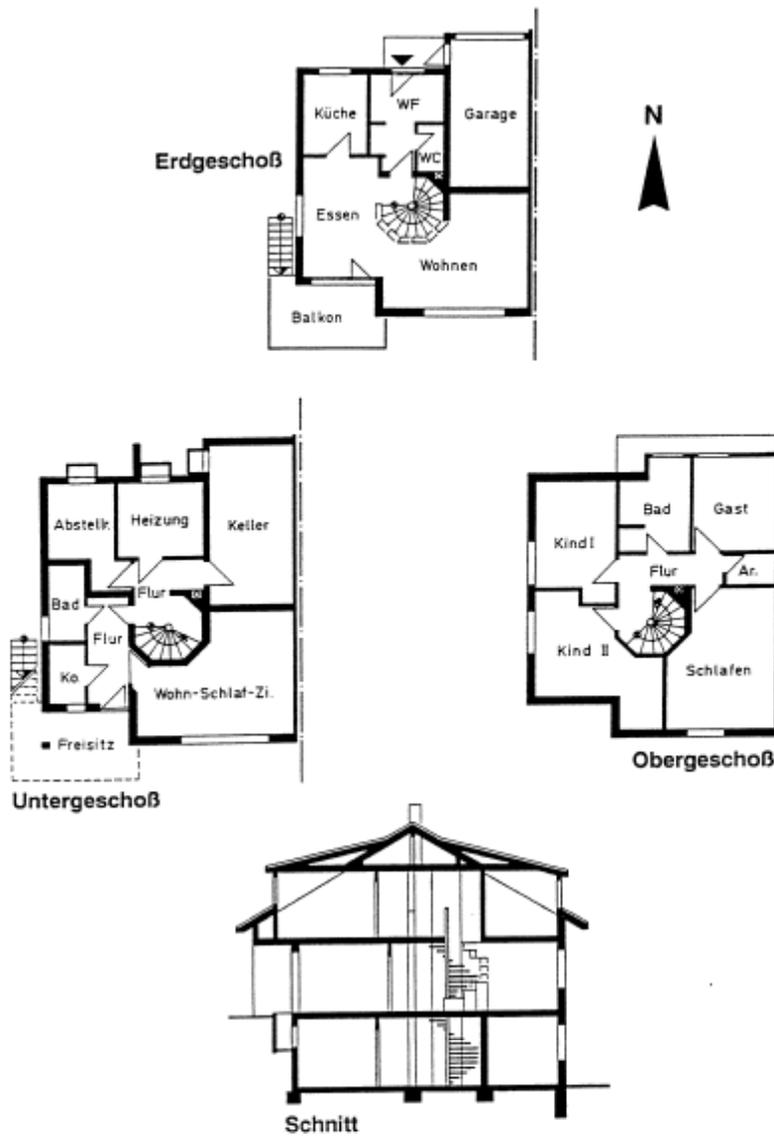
Darstellung der Grundrisse aller Geschosse und eines Schnittes des Referenzhauses (Reiß und Erhorn 1994)
